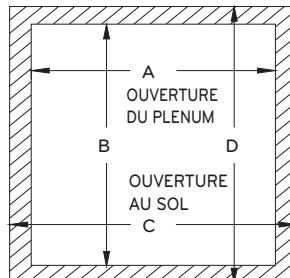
Dimensions de l'ouverture du sol et du plénum
